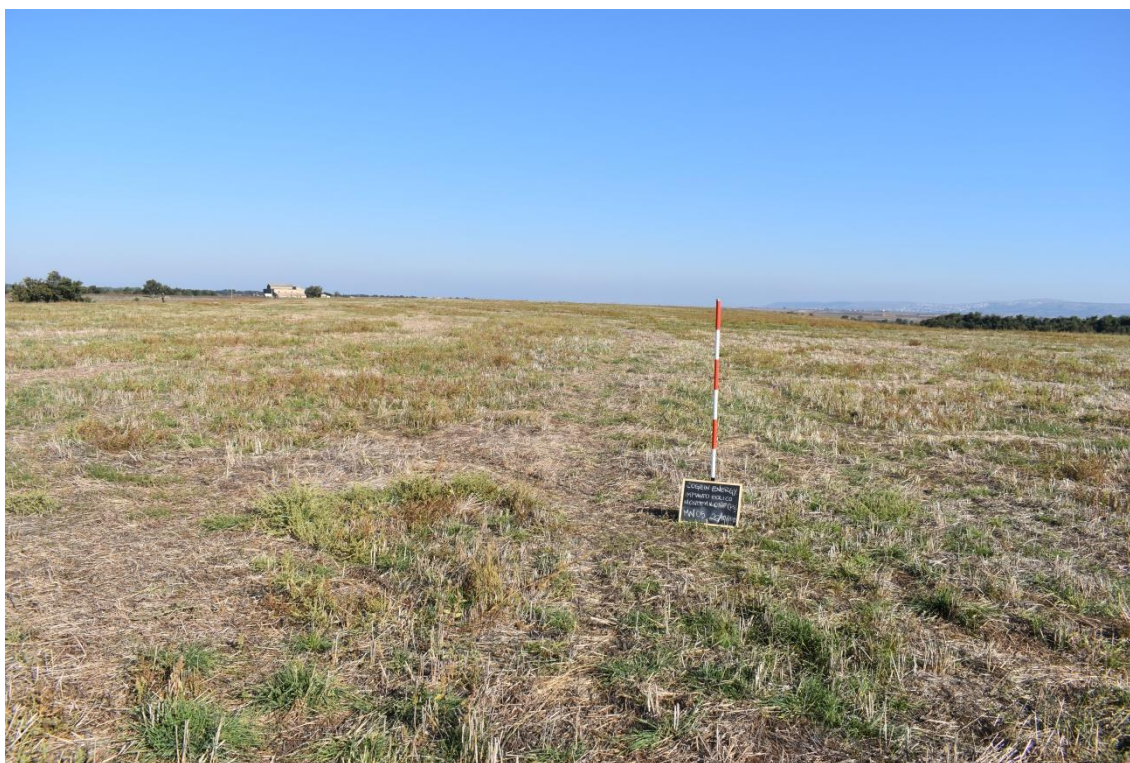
POSIZIONE AEROGENERATORE MN05 VISTA DA N
